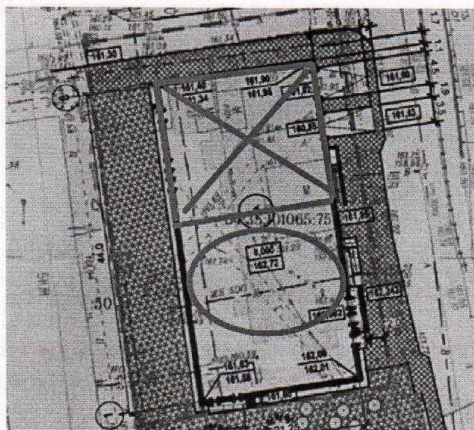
(На зоне выделенной квадратом уже построен подземный этаж и возводятся колонны первого этажа. На зоне указанной овалом вырыт котлован и возводится фундамент.)
